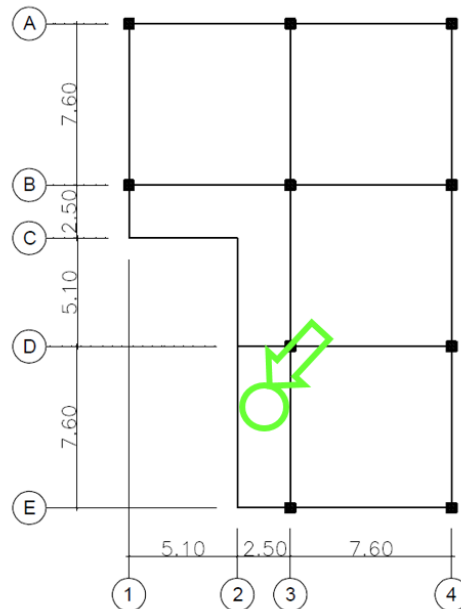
Ubicación de losa nervada con corrosión del refuerzo
